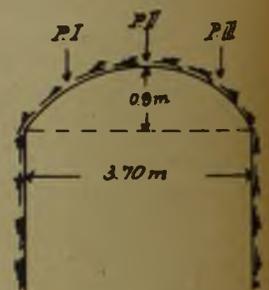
Aufhauen mit rundem Stoß und Härtepunkte.
